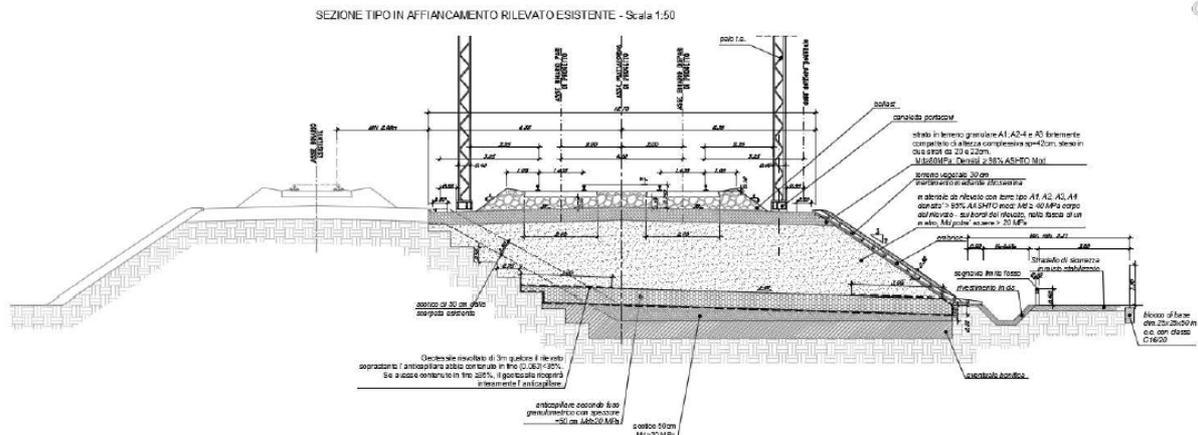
Sezione tipo rilevato in affiancamento rilevato esistente
